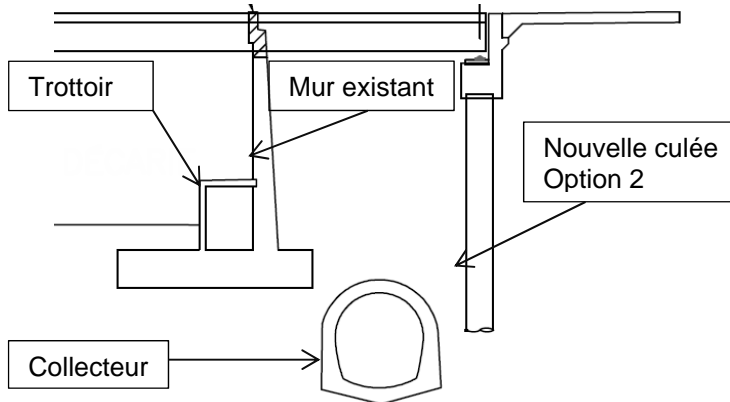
Nouvelle culée au droit du mur de soutènement existant côté est
